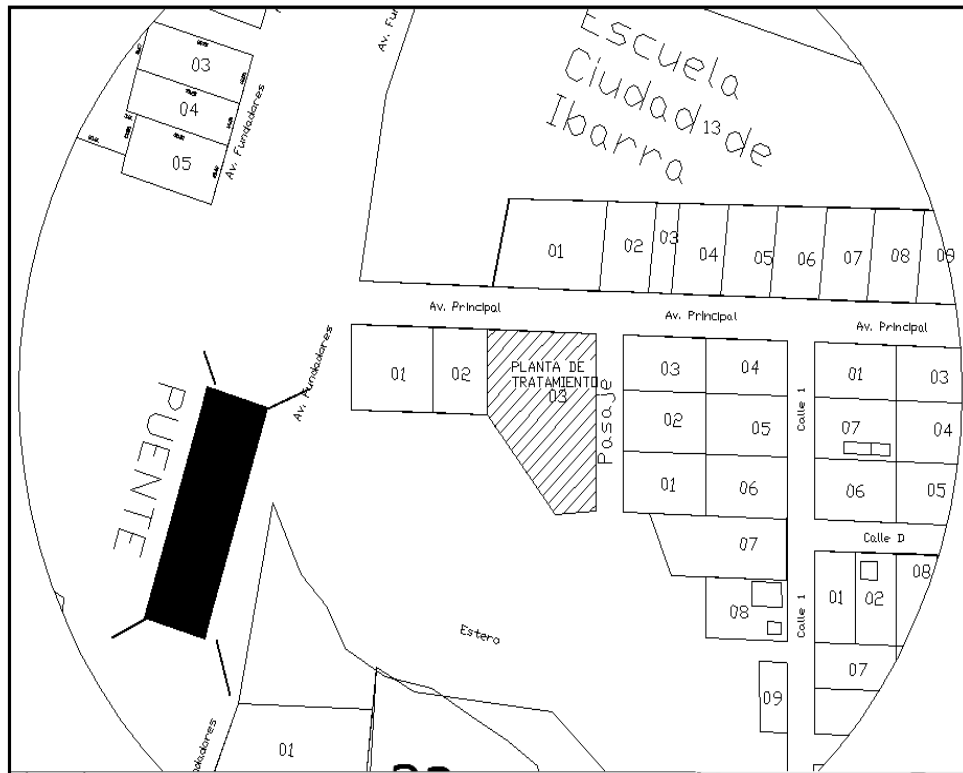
Ubicación de la Planta de Tratamiento N° 01 – Cantón La Joya de los Sachas
